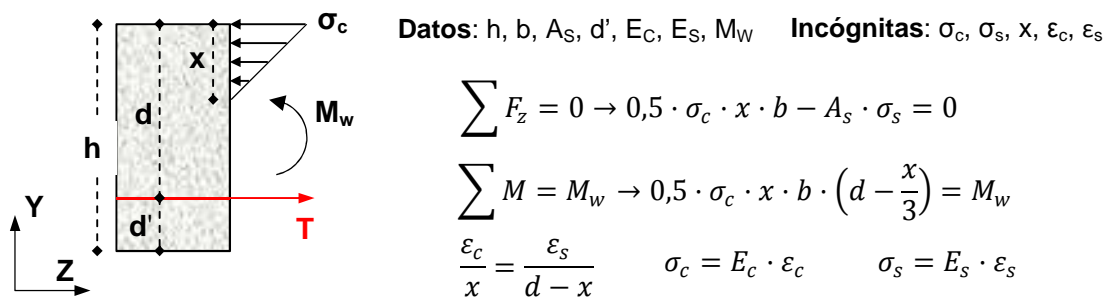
Cálculo seccional de la losa 3I, en estado fisurado
